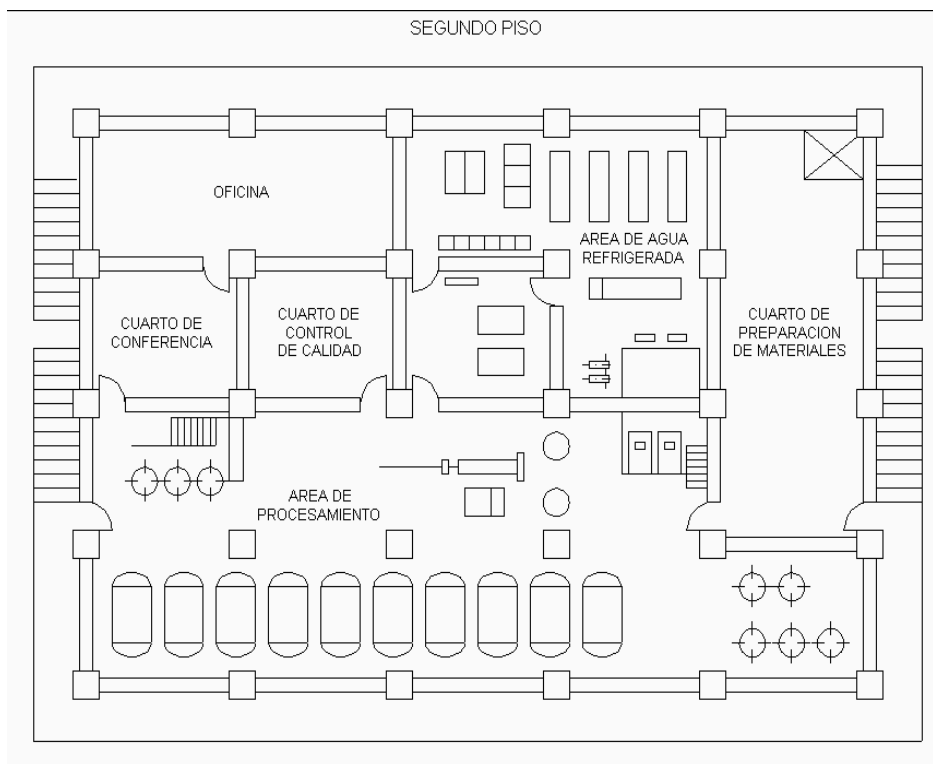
LAY OUT PLANTA DE BEBIDAS ÁREA DE PREPARACIÓN
